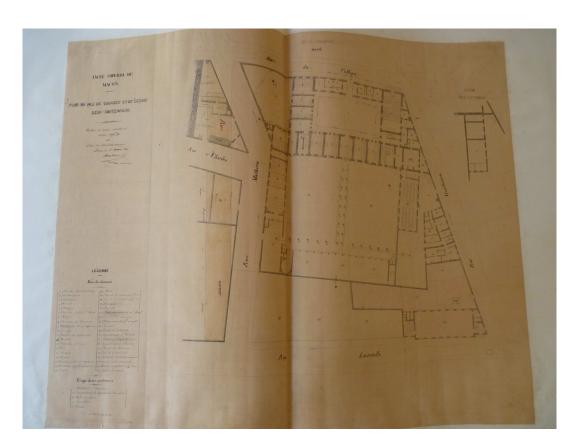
Plan du rez-de-chaussée du lycée de Mâcon en 1861 (AN F/17\*/2555)
